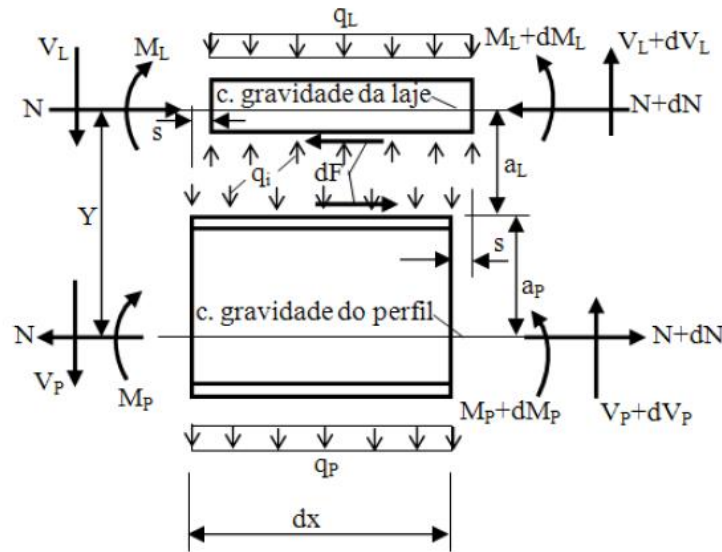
Viga mista e carregamentos. (Queiroz et al., 2009)
